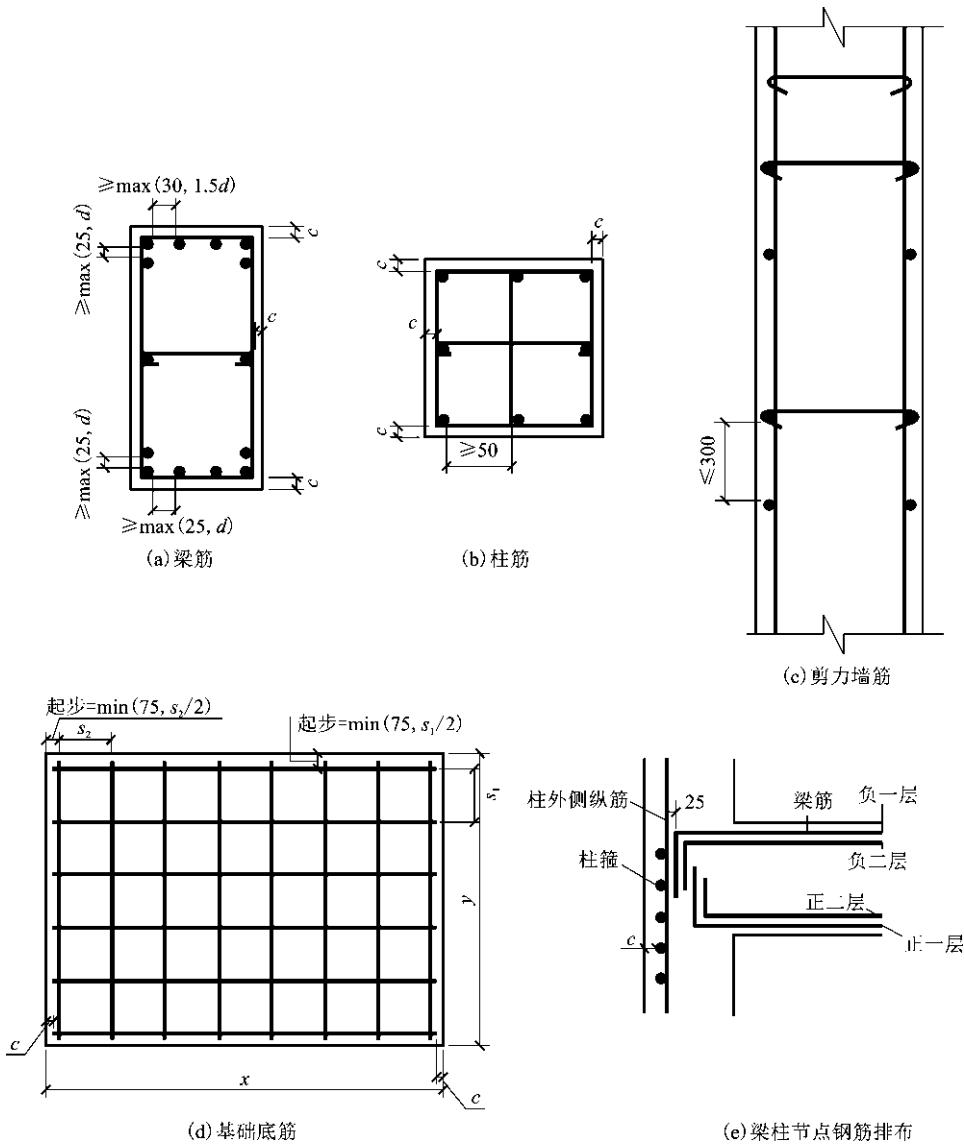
钢筋的混凝土保护层厚度及钢筋净距
